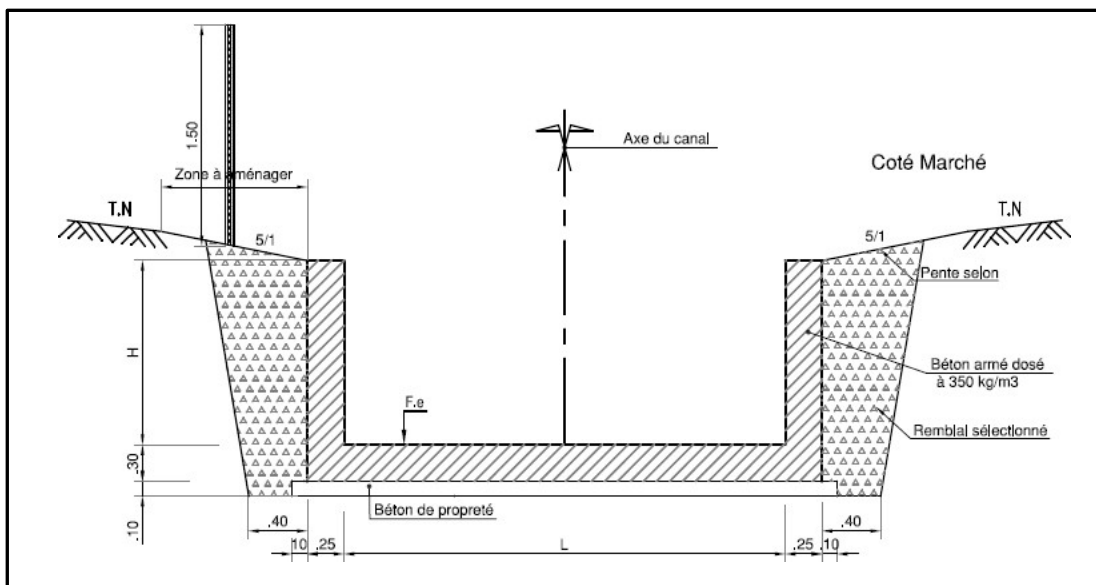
Section type canal rectangulaire en béton, Source : APD.
